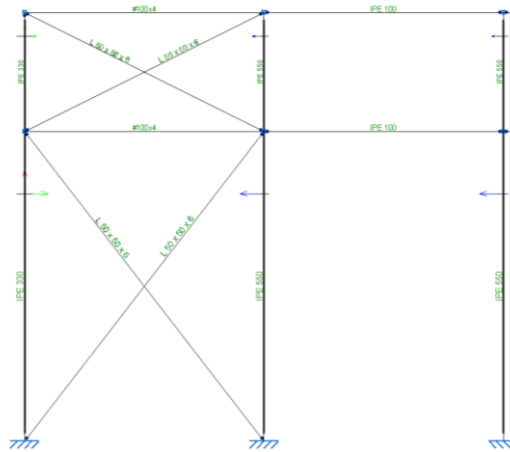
Detalle perfiles fachada lateral principal
